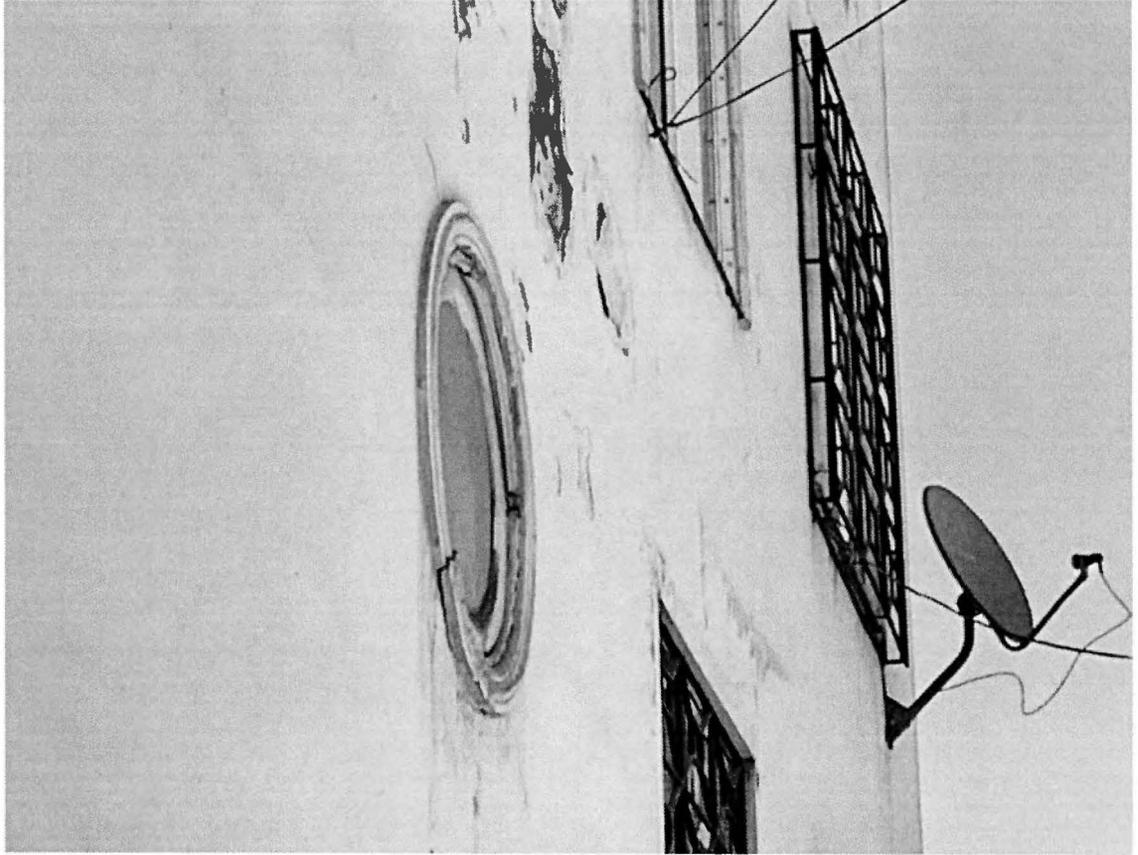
Desprendimiento de molduras de hormigón y pinturas sueltas en fachada norte.
